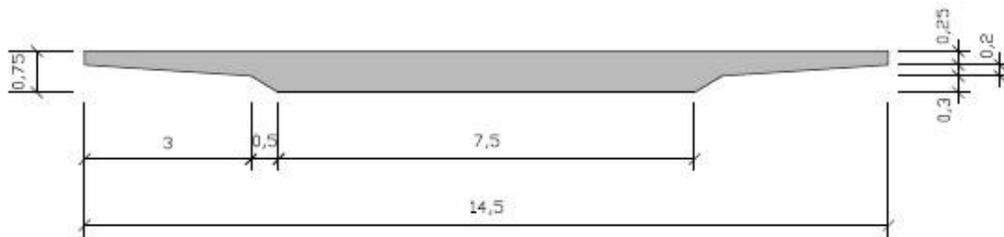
Sección transversal del tablero de los Pasos elevados.
